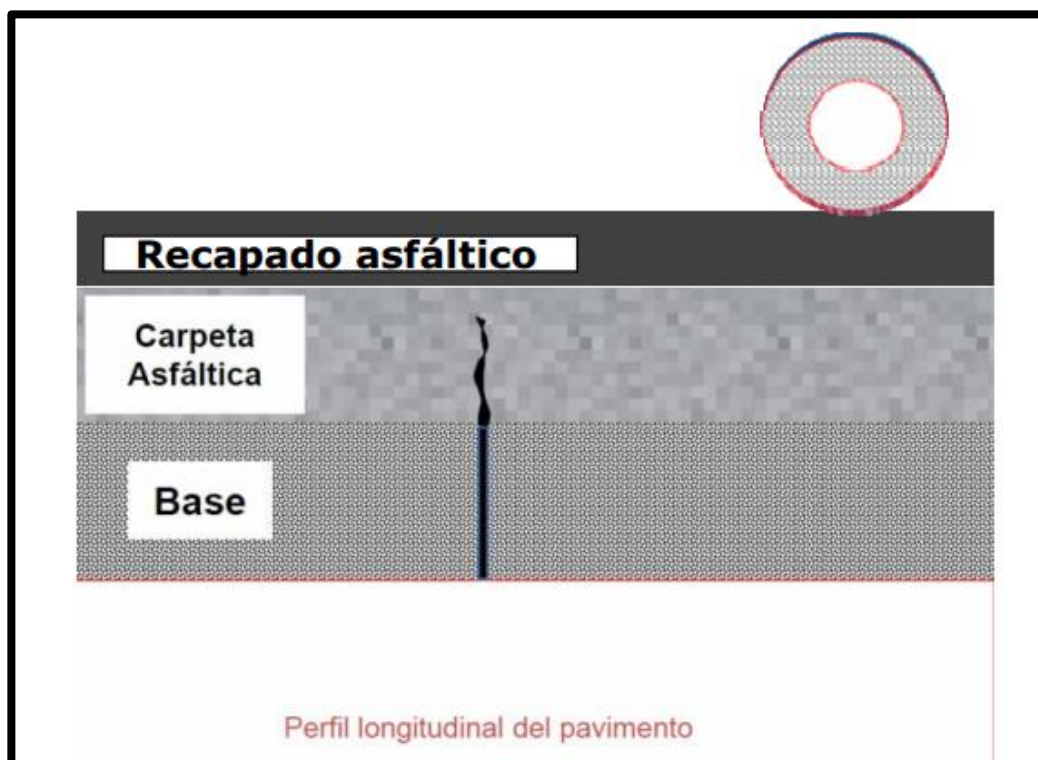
Fisura bajo un Recapado Asfáltico. Fuente [8].
